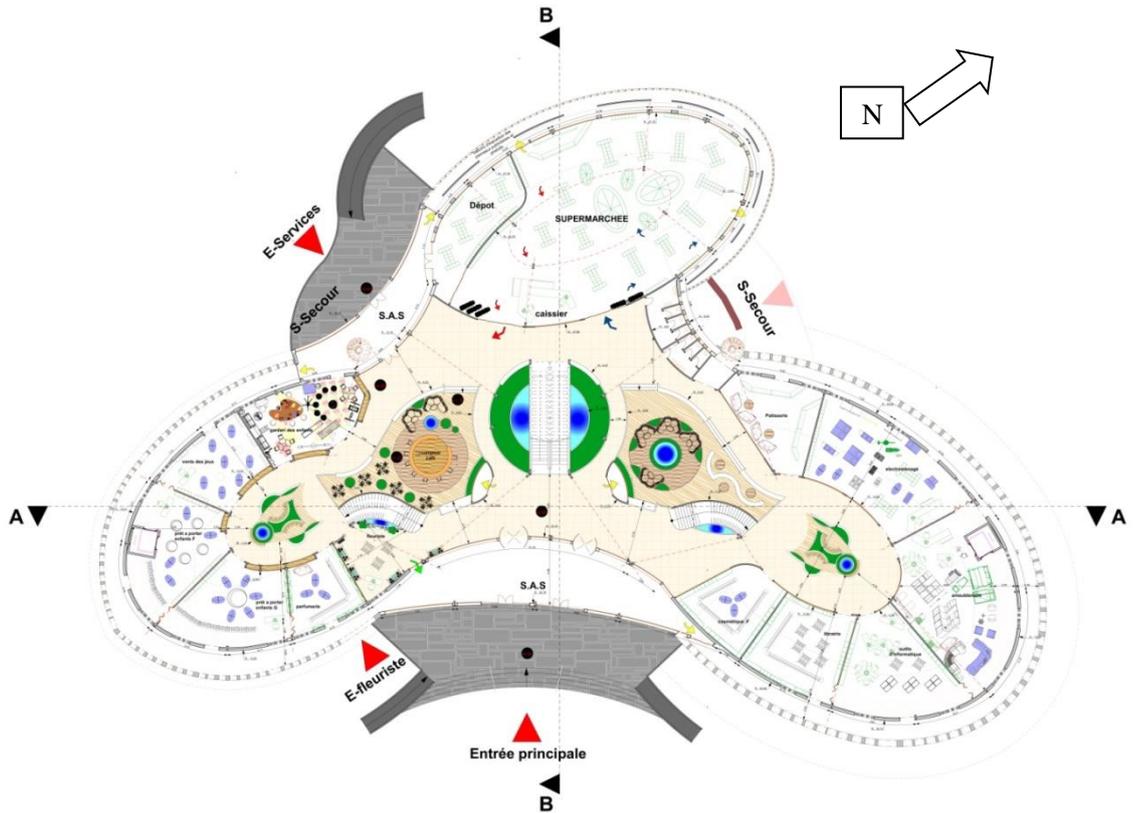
Plan de Rez de chaussée Source : auteur ,2020
